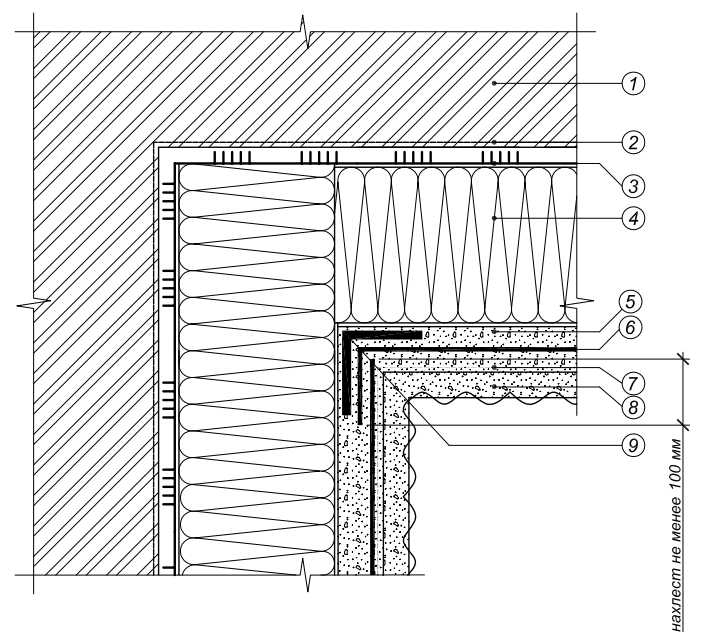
Устройство системы на внешнем вертикальном углу здания
